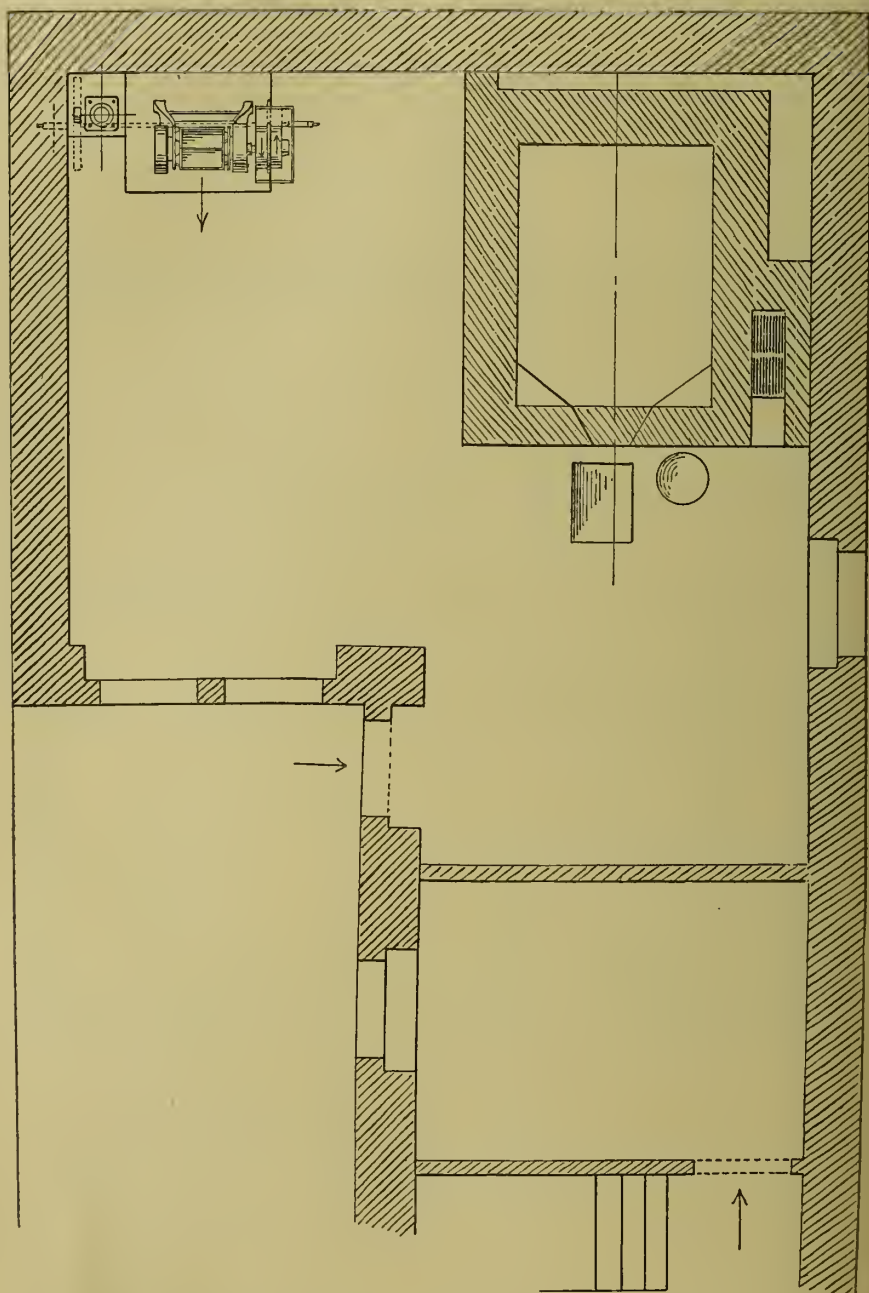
Grundriß einer Bäckerei mit Maschinenbetrieb.
